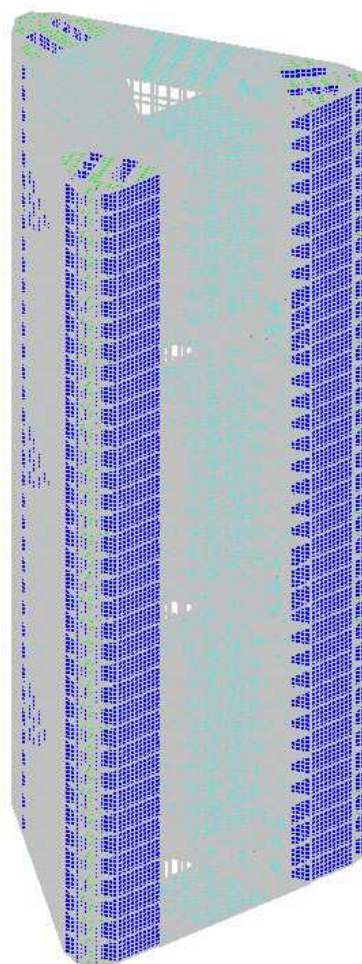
Расчетная схема здания в ПК SCAD
